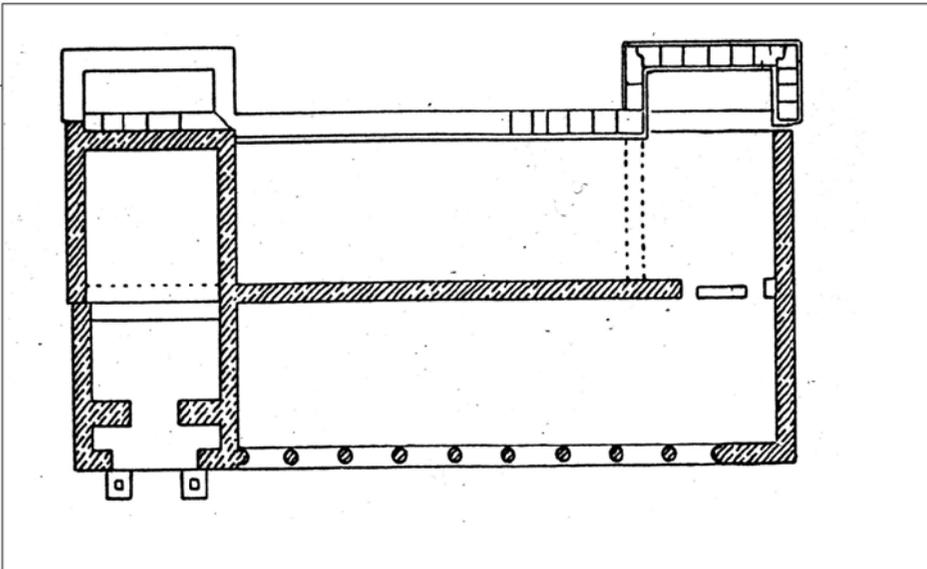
Edificio con paraskenia E-8. Planimetría esquemática de todas las fases (ANTI 1947)
